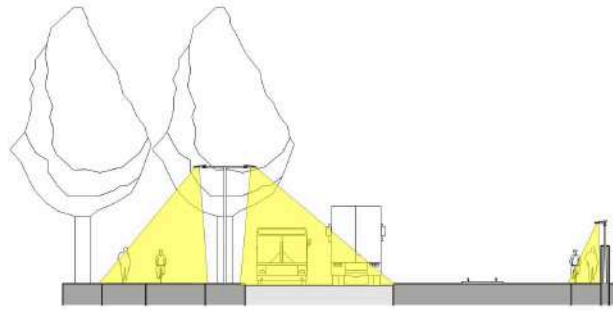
Schnitt D1 der Planstraße C basierend auf dem städtebaulichen Entwurf
